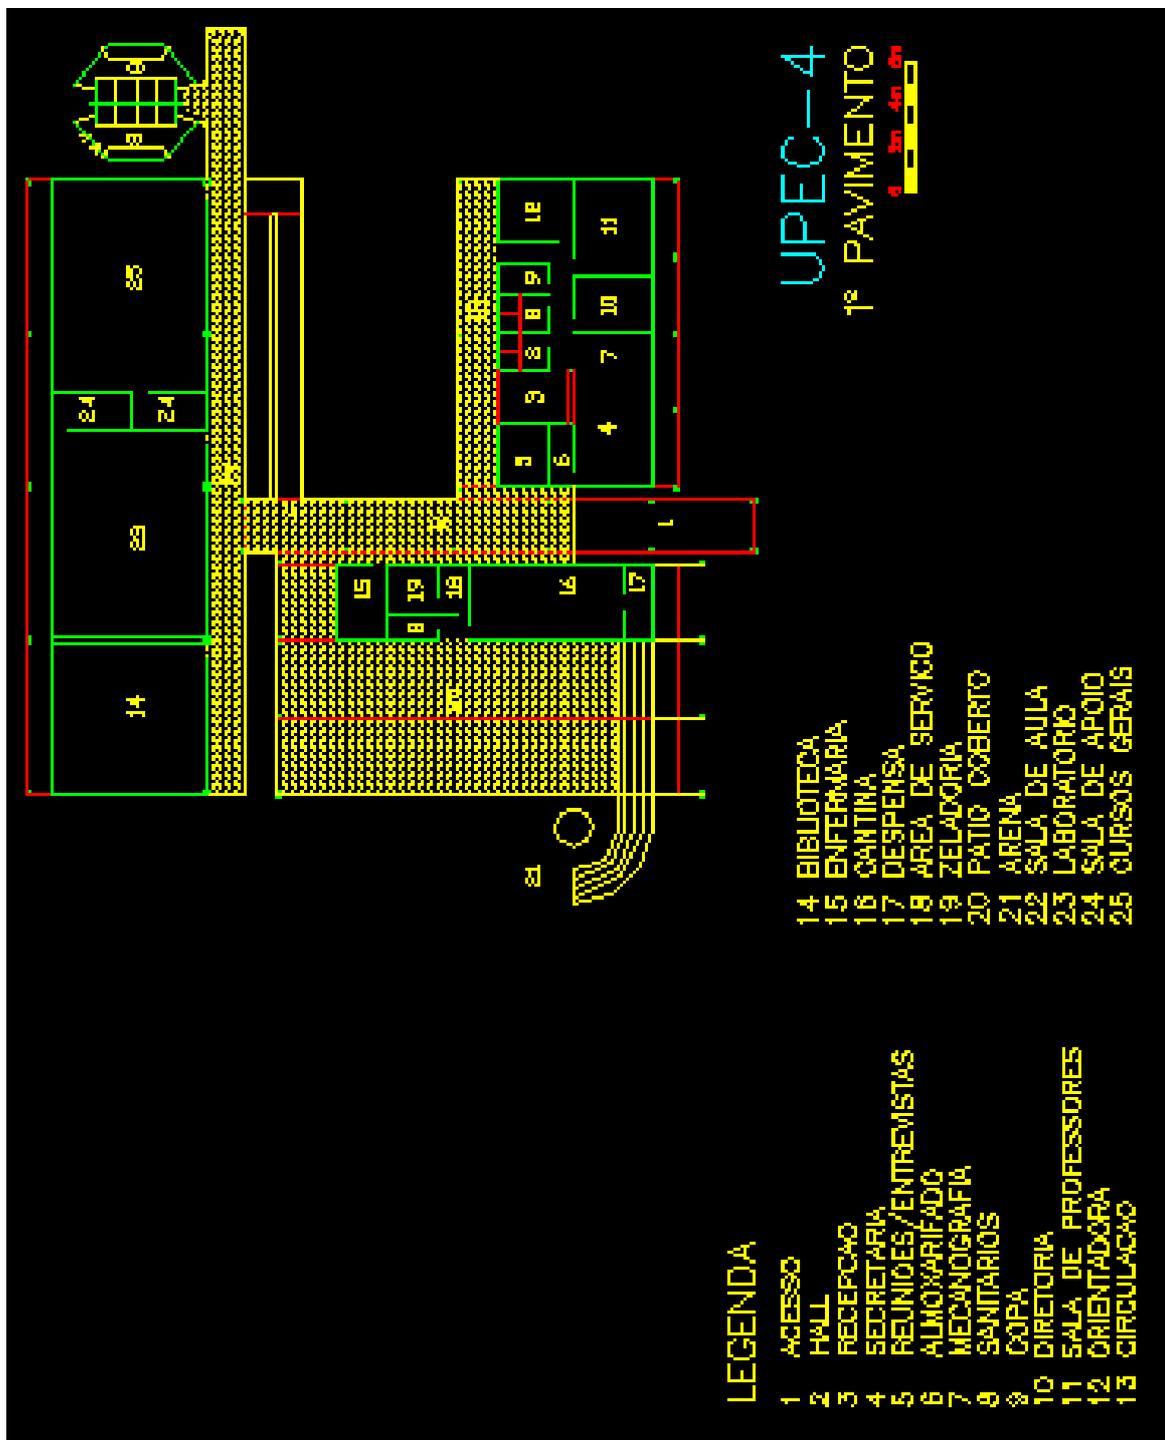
UPEC-4 / PLANTA 1º NÍVEL
